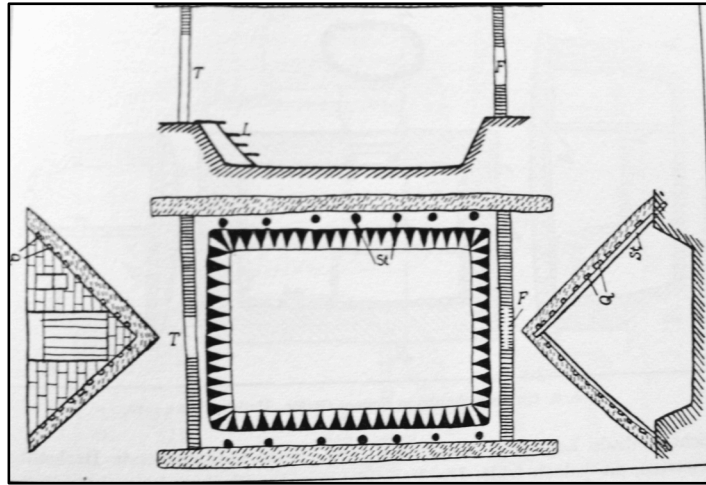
Konstruktionsgerüst einer Grubenhütte in Rákosszaba
